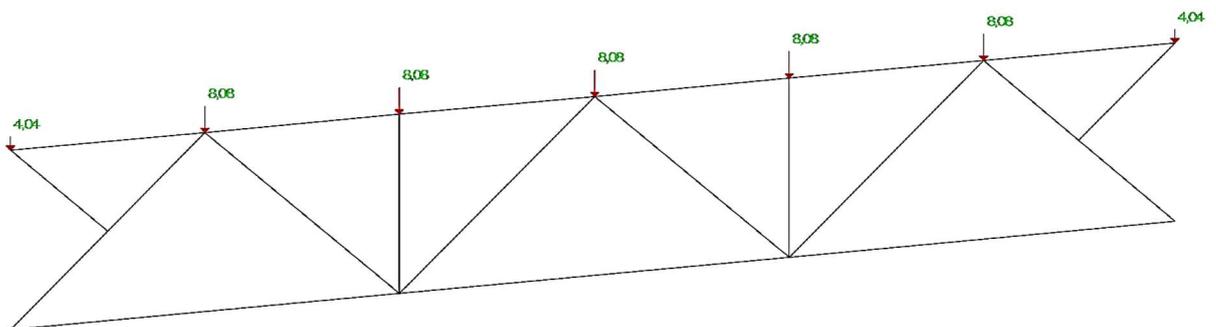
Схема приложения нагрузки от покрытия на ферму
